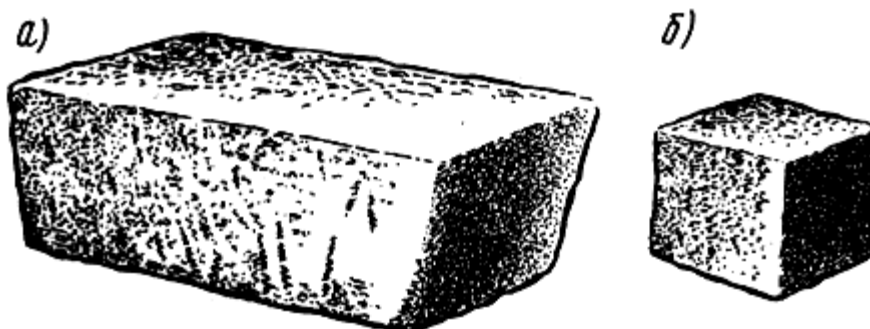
Брусчатка и шашка для мозаичной мостовой:
